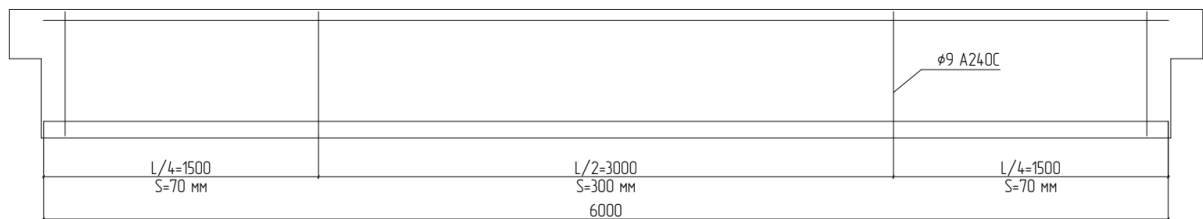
Схема розташування поперечної арматури по довжині балки
